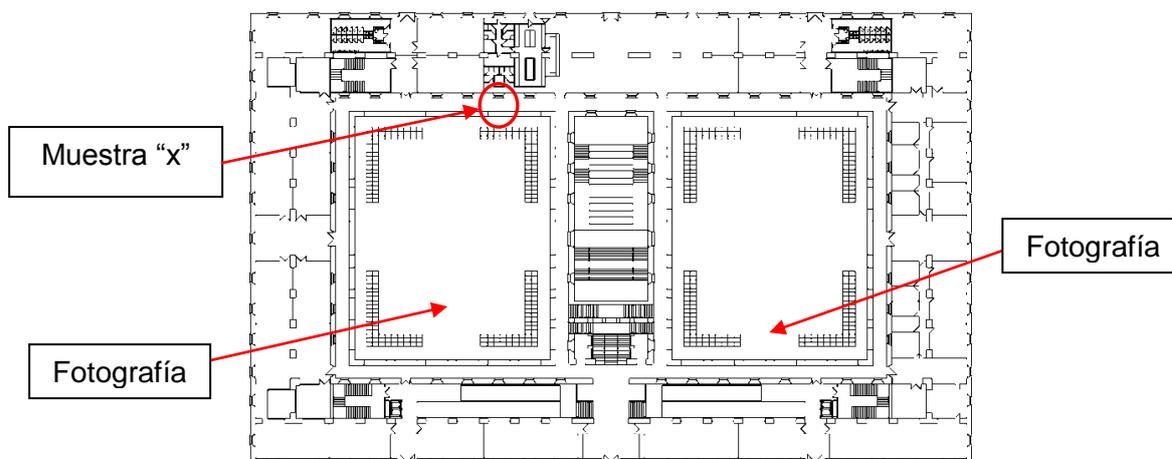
Plano planta del edificio. Localización y ubicación de la toma de muestras y fotografías realizadas. (Fuente: Los autores)
